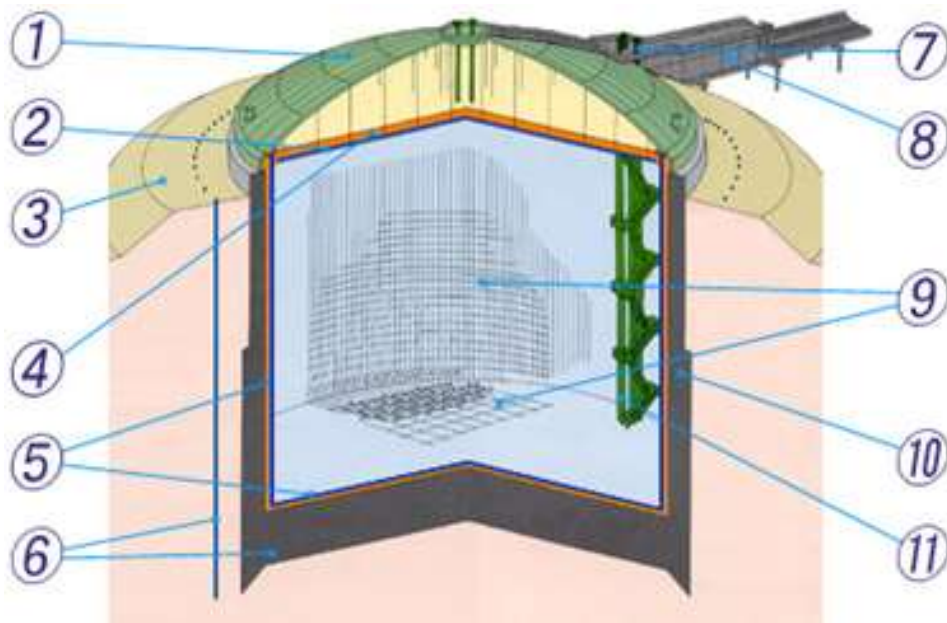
Заглиблений резервуар з підвісною платформою:
